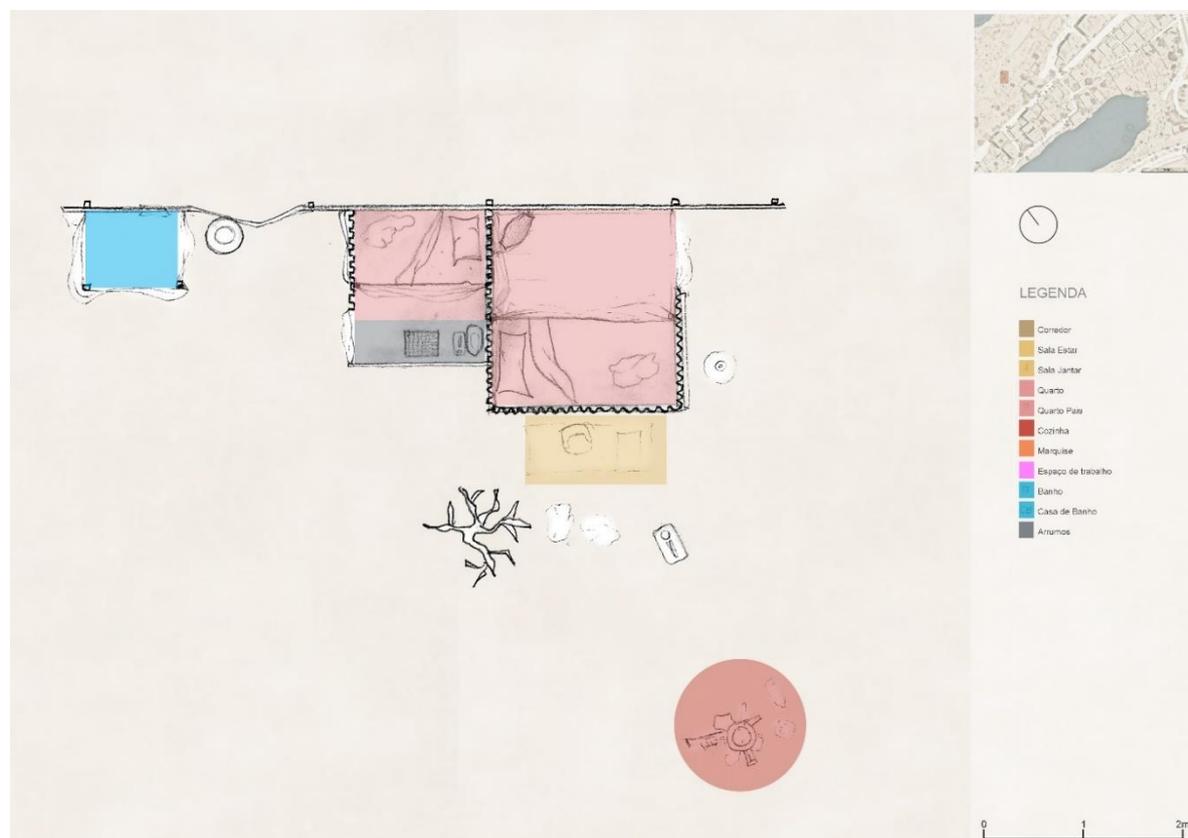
Usos da Planta Casa 4, em 2020. Levantado e desenhado pela autora.
